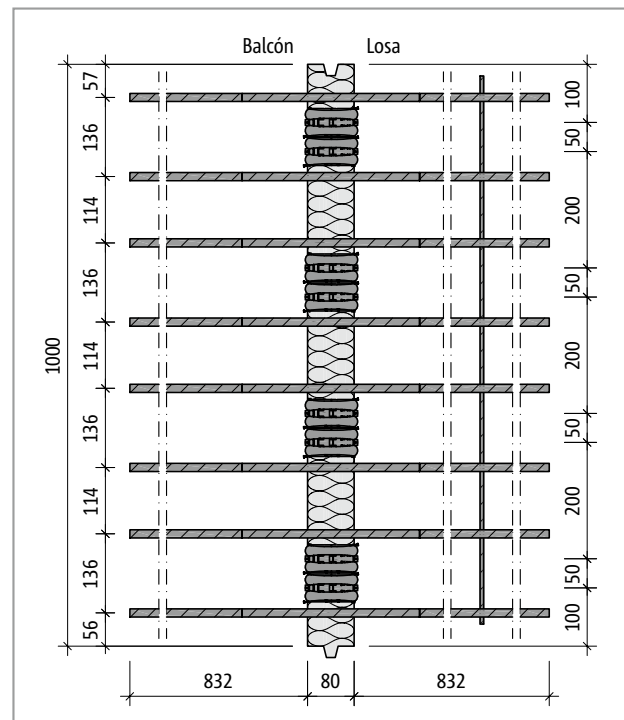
Schöck Isokorb® T tipo Q-V12: Plano del producto
